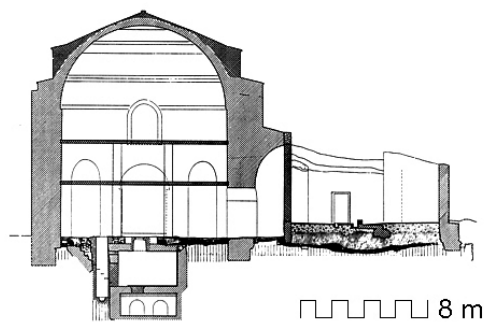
Sección interior de las dos salas de Centcelles (SCHLUNK, HAUSCHILD 1962)
